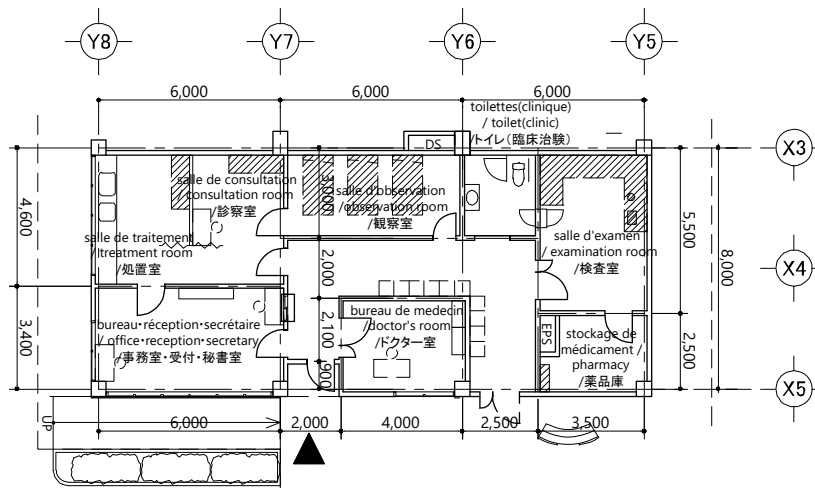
Vue en plan du centre d'essais cliniques (avant-projet)
